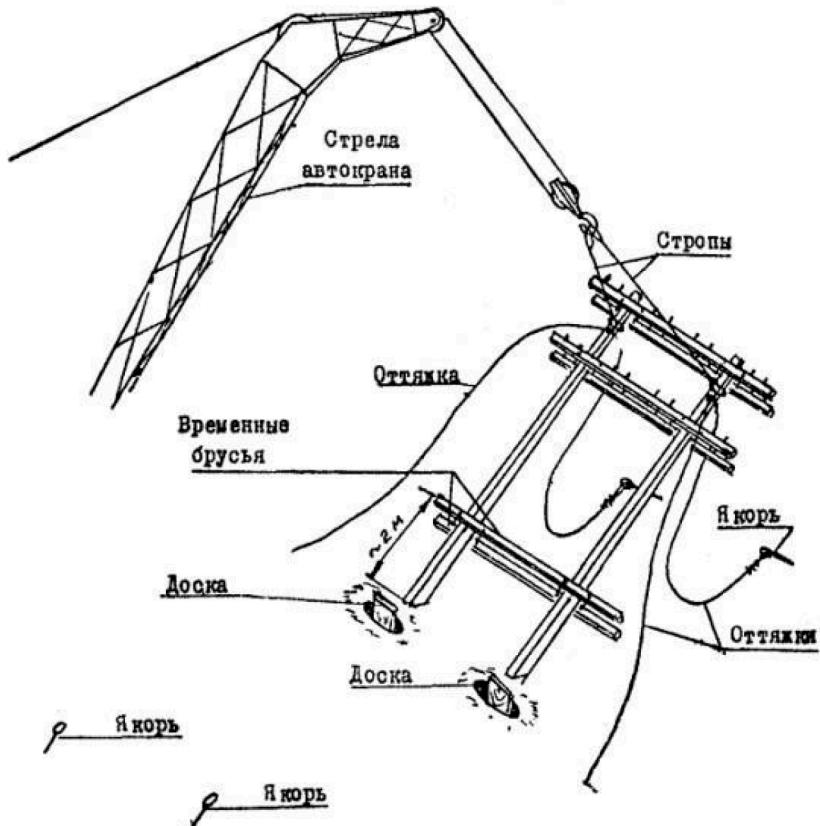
Схема установки двухстоечной (анкерной) железобетонной опоры
